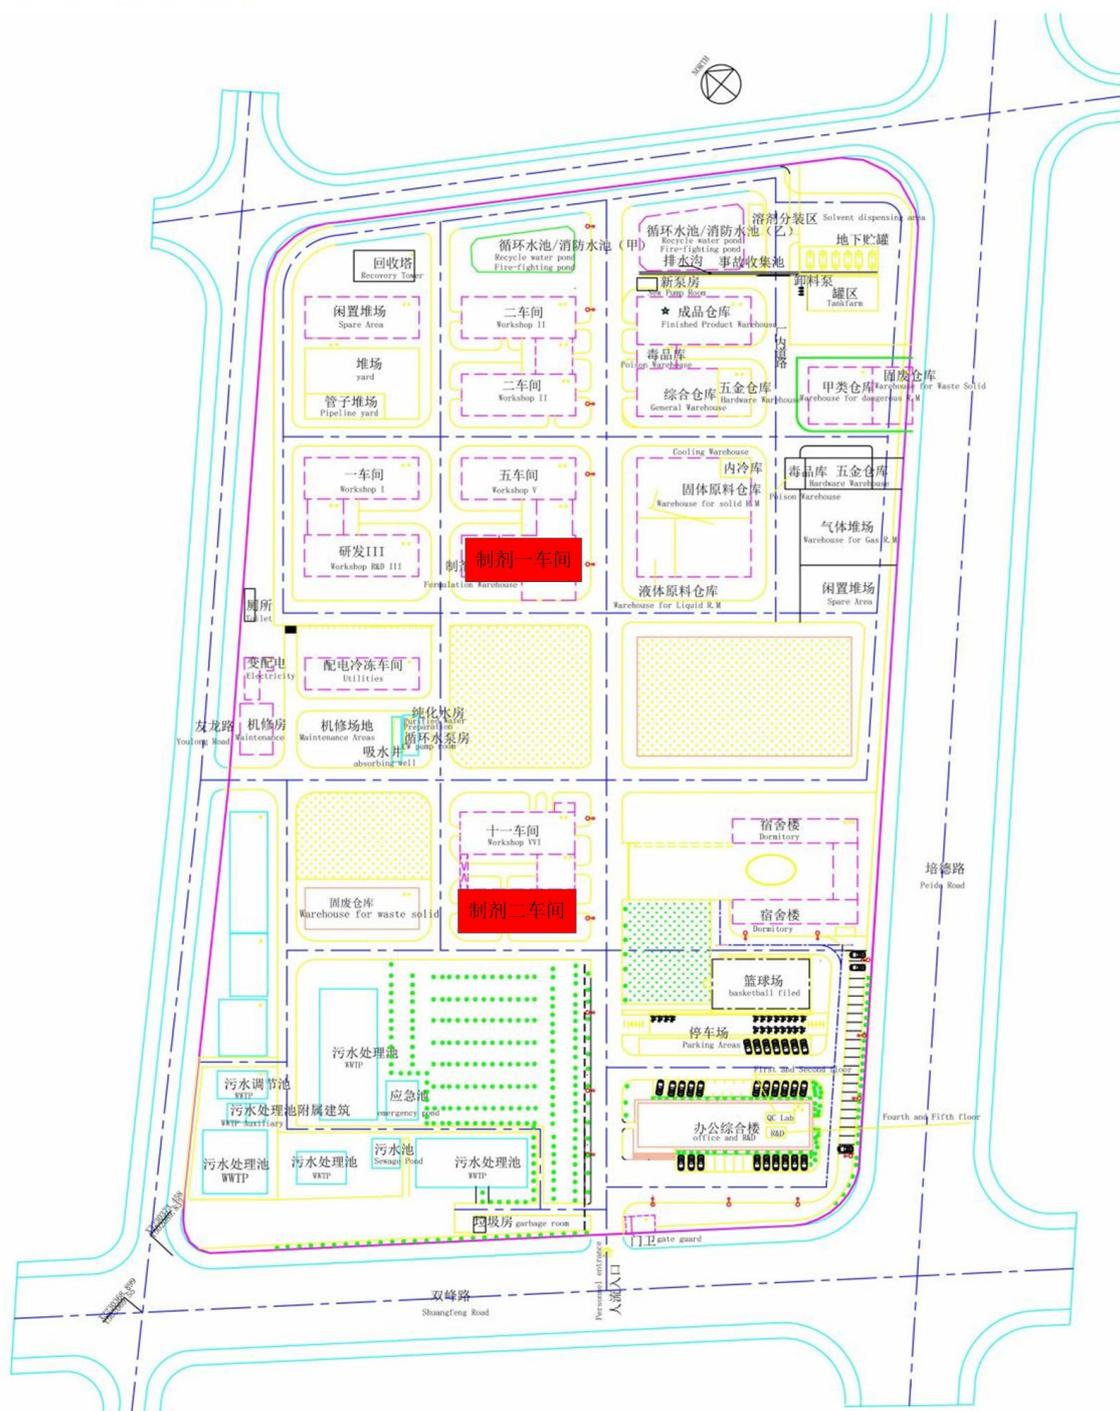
本项目环评厂区平面布置图（填充色块区）
